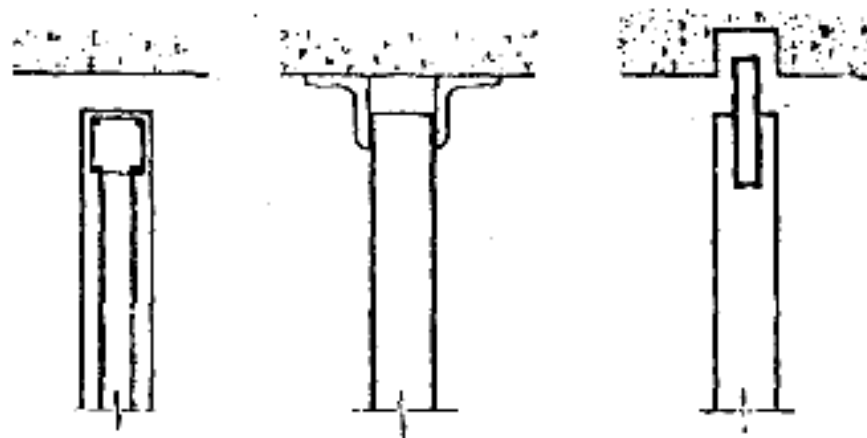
Alternativas para desligar los muros de la estructura en elevación (ref. 16)
